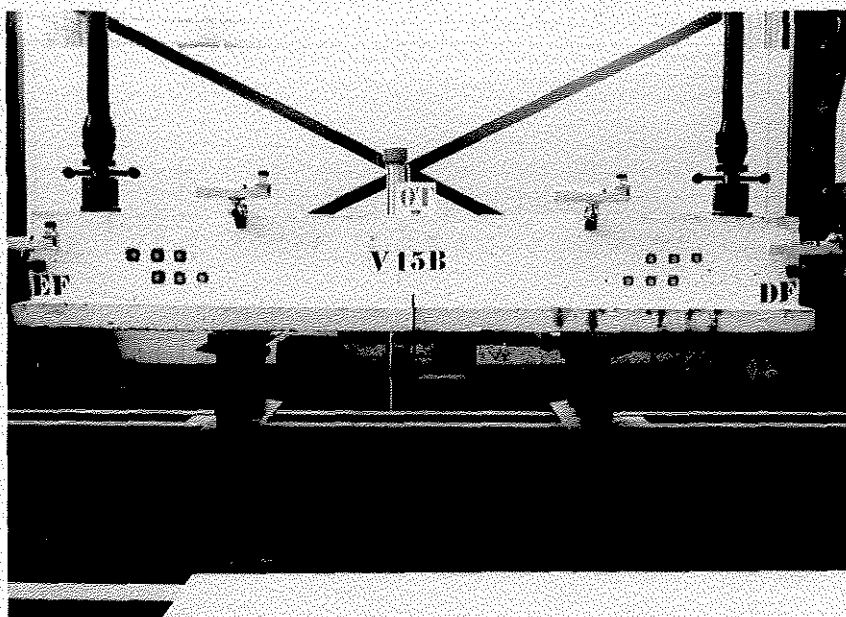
Vista geral do início do ensaio da viga V15B.
